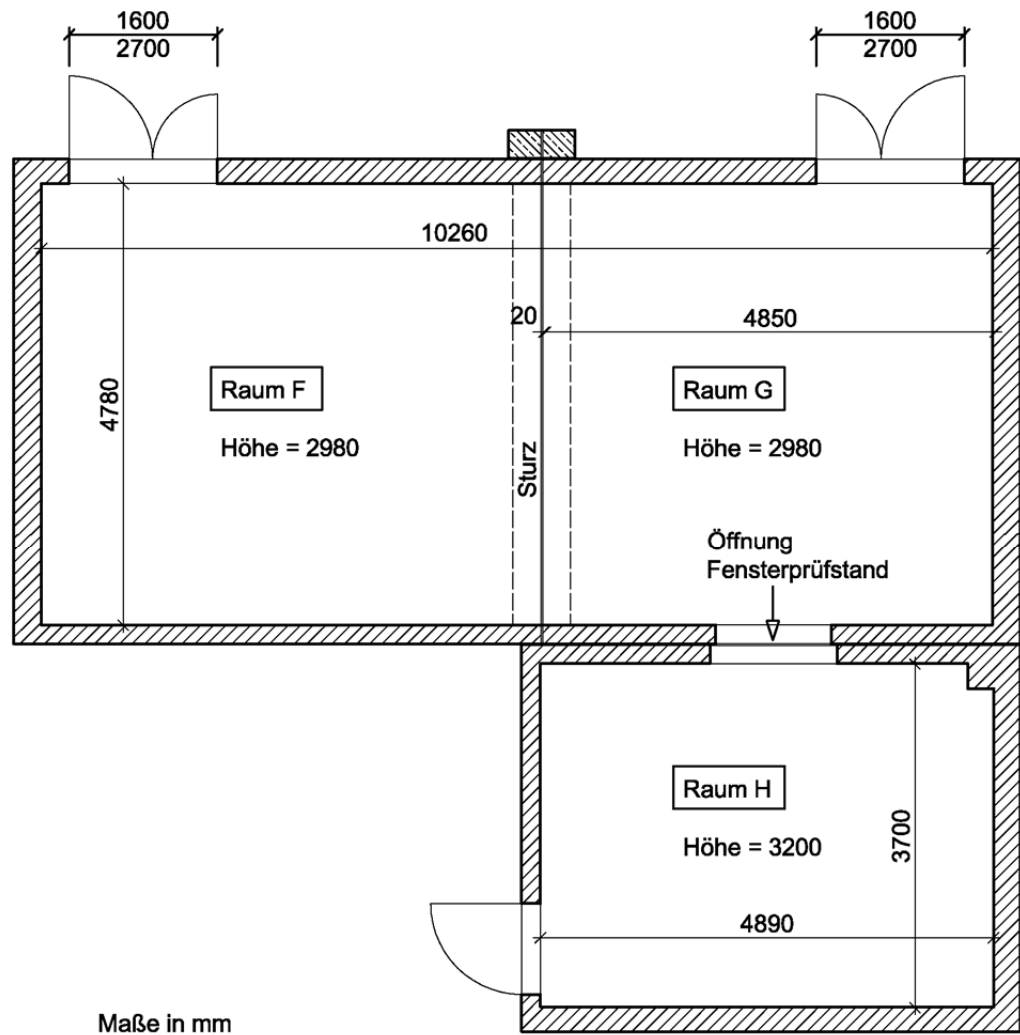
Grundriss des Wandprüfstands.
